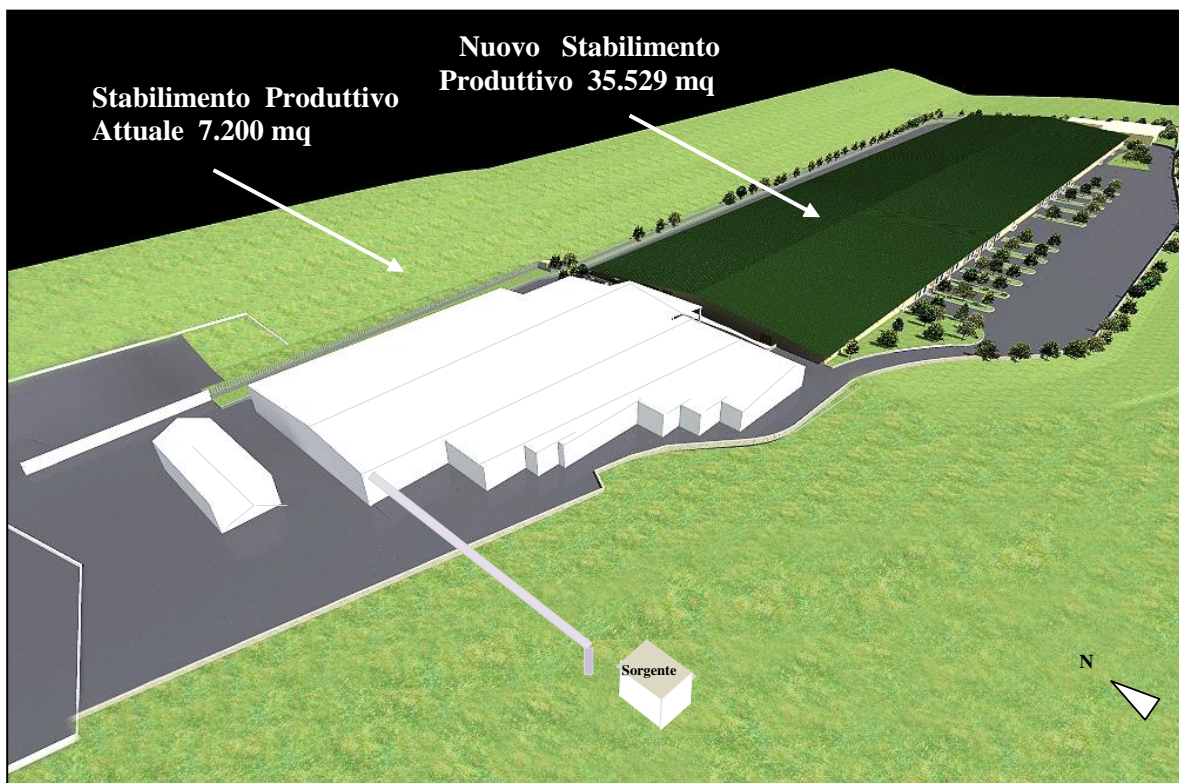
Render del progetto (vista da ovest località Villa Paradiso)
